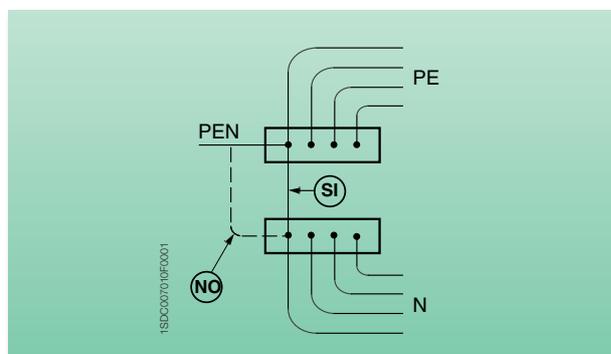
/2 - Collegamento del PEN al giunto di separazione.
